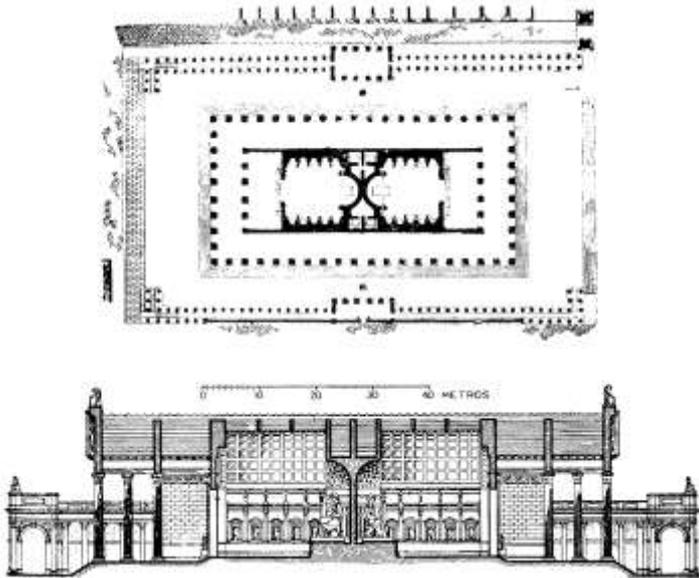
Templo de Venus y Roma, planta y alzado.
